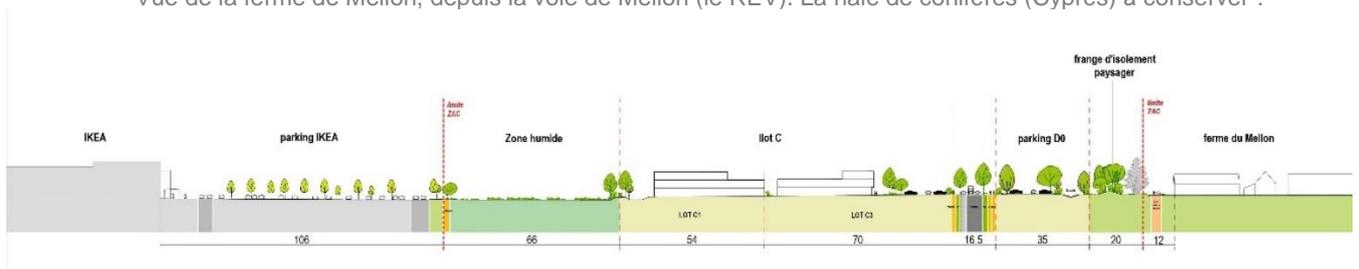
coupe B - Profil en travers est-ouest au niveau de la ferme de Mellon
